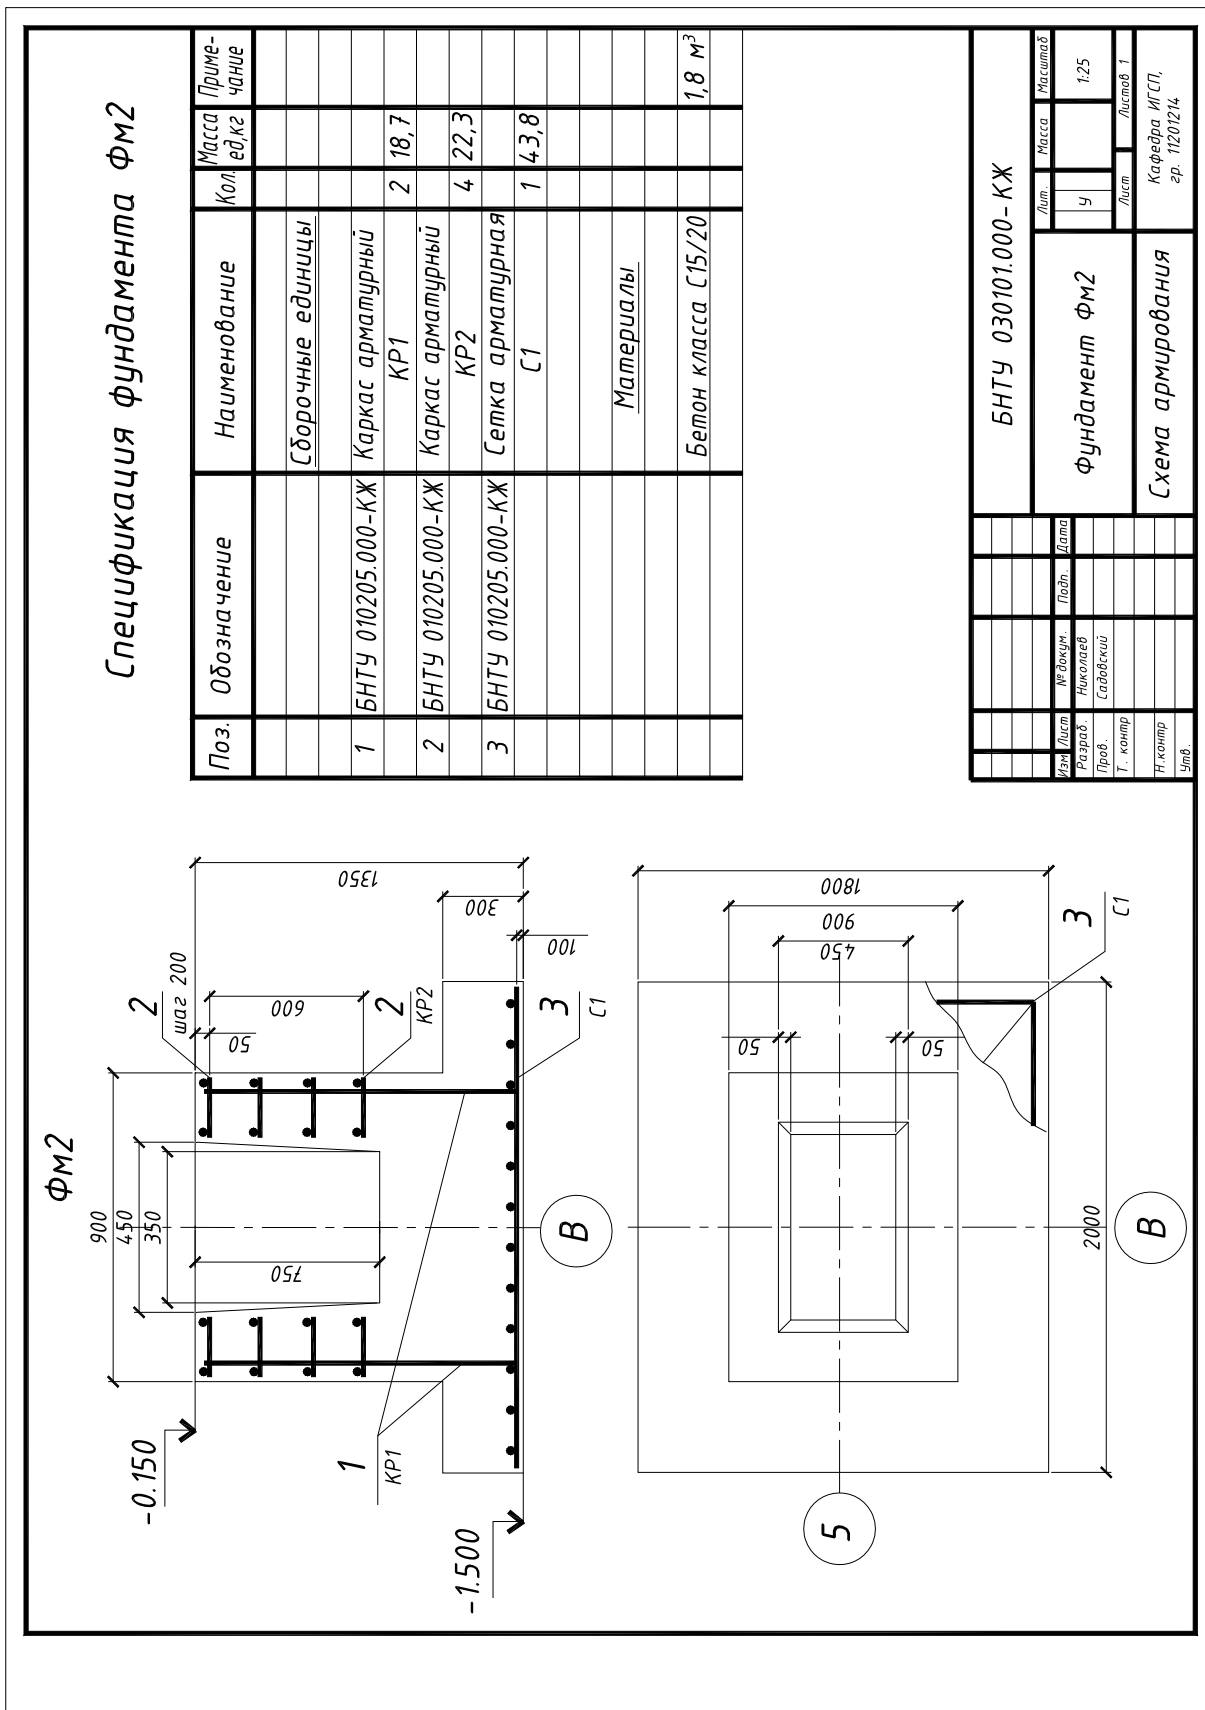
Пример оформления лабораторной работы № 6 «Схема армирования стального фундамента»
